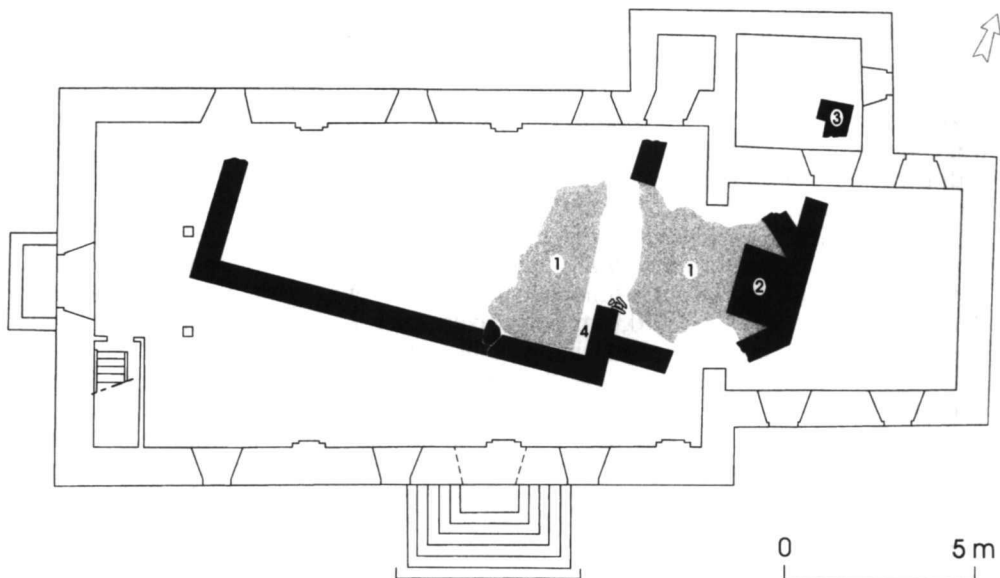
Ritzingen, Grundriss der bestehenden Muttergotteskapelle mit den Ueberresten des Vorgängerbaus:
